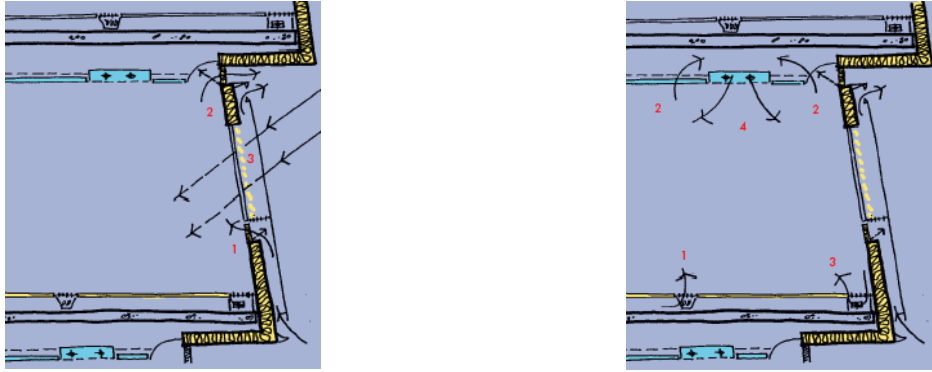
Схема естественной и механической вентиляции помещений: [9].
